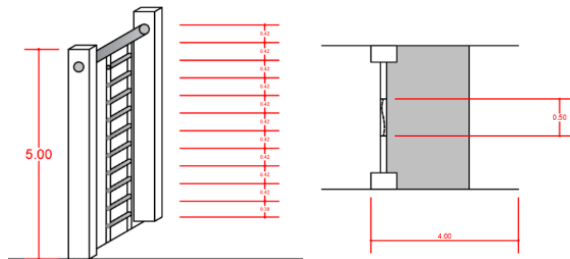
Vista en planta y lateral del obstáculo.
